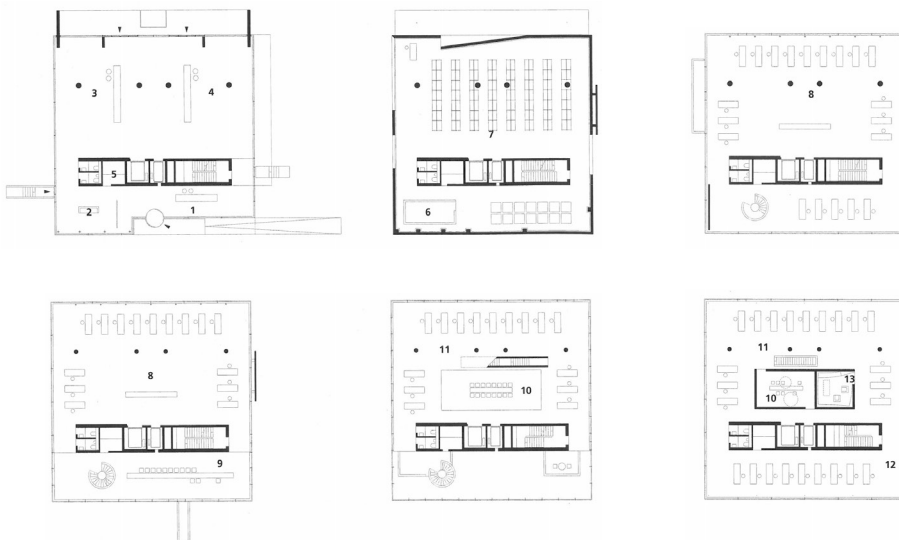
Gebäudegrundrisse v.l.n.r.: EG, 1.OG, 2.OG, 3.OG, 4.OG und 5.OG
